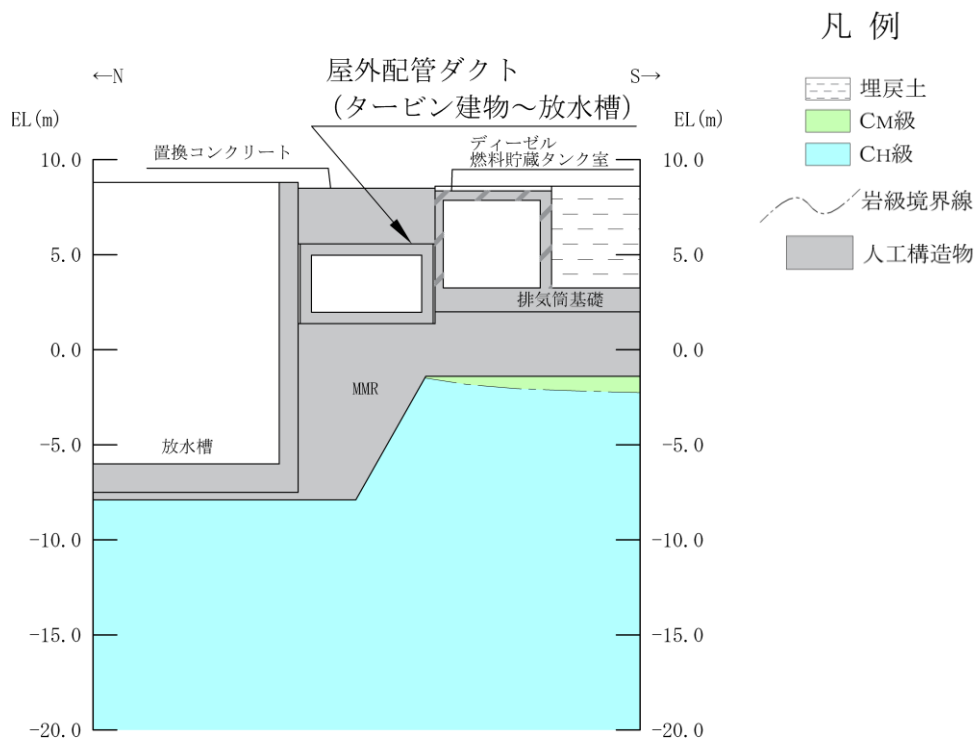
屋外配管ダクト (タービン建物～放水槽) 評価対象断面図 (A-A 断面位置)
